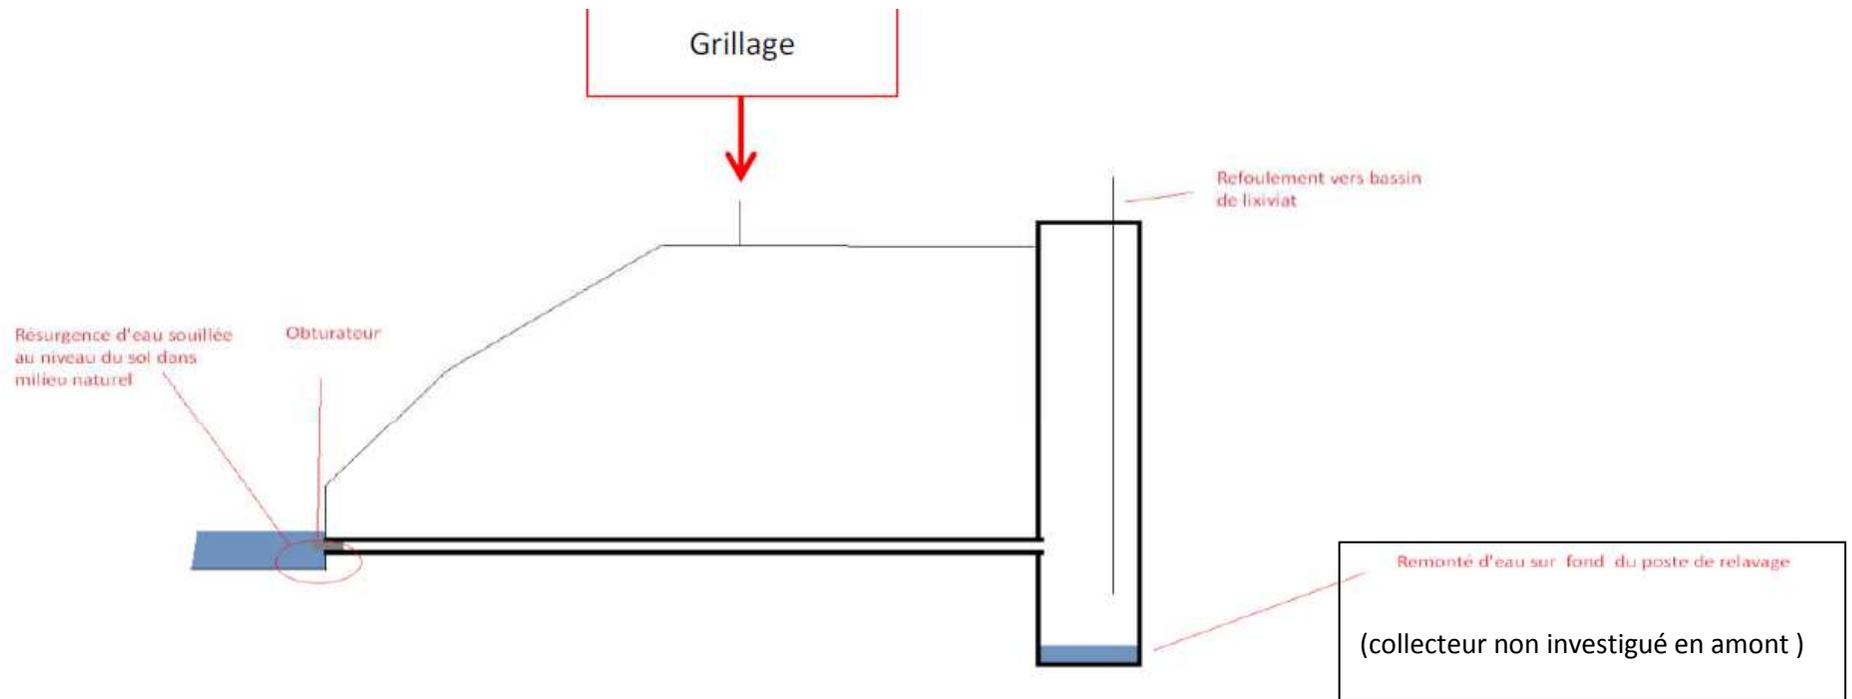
coupe de principe du raccordement de la conduite au puisard et
